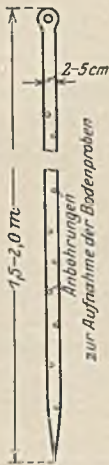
Schürfeisen zur Prüfung des Baugrundes bei geringen Tiefen.
